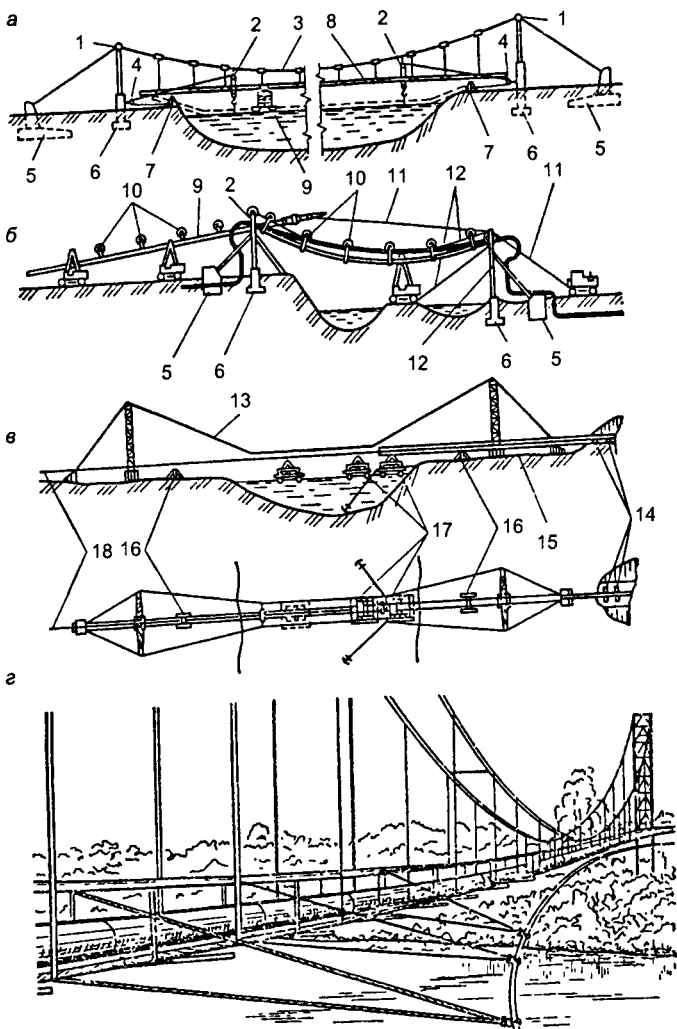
Монтаж подвесных и висячих трубопроводов:
